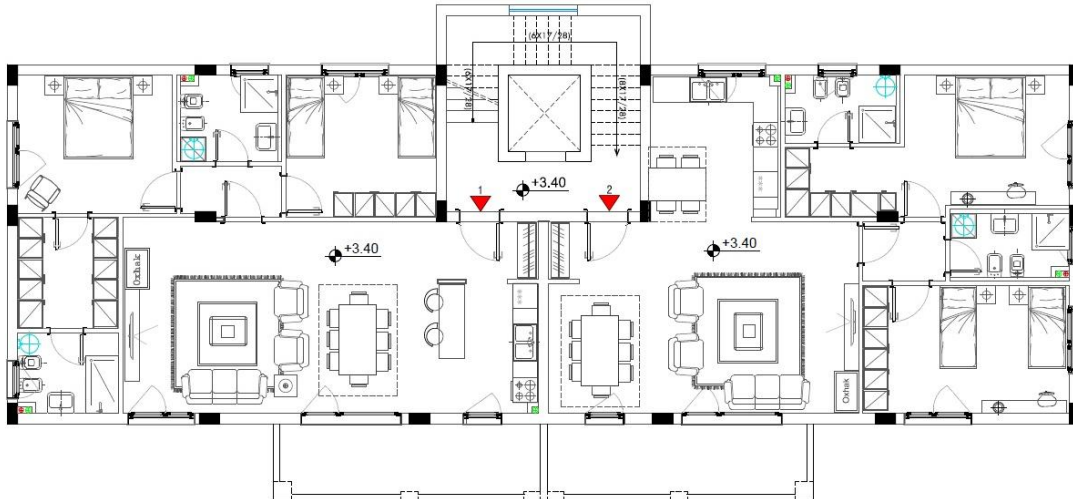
Banesa shumëfamiljare (A), plani i katit të parë.
